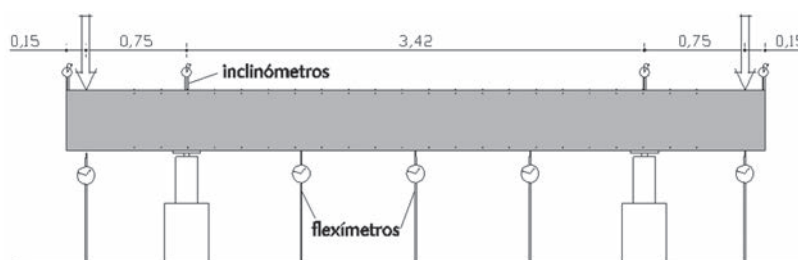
Esquema de ensayo de vigas a fisuración con una zona de 3,42 m sometida a flexión constante.
